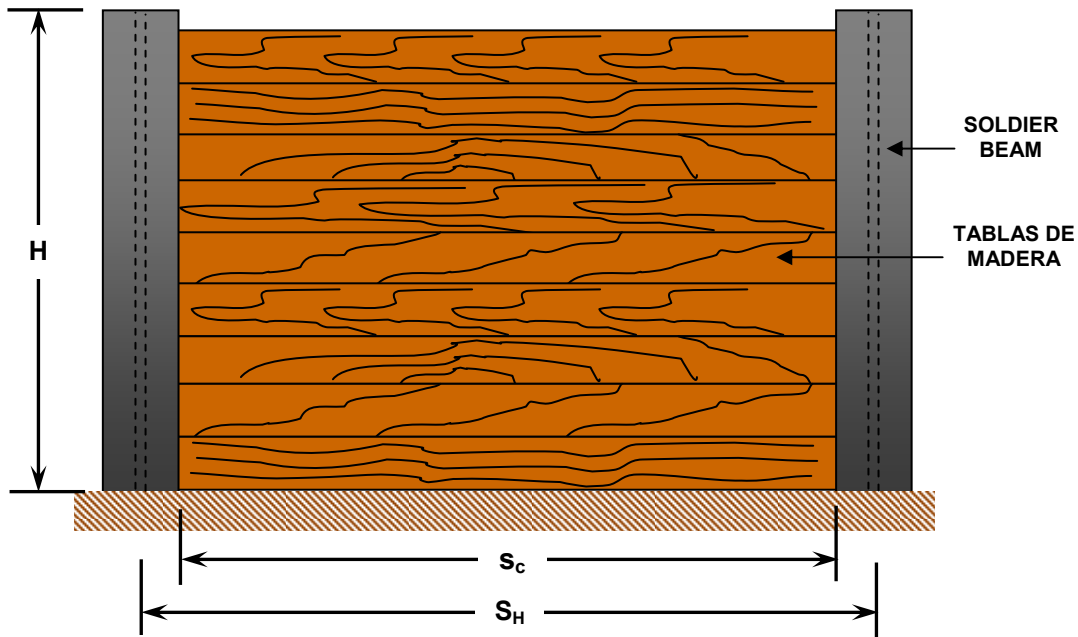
Vista de separación horizontal y separación horizontal limpia entre soldier beams.
